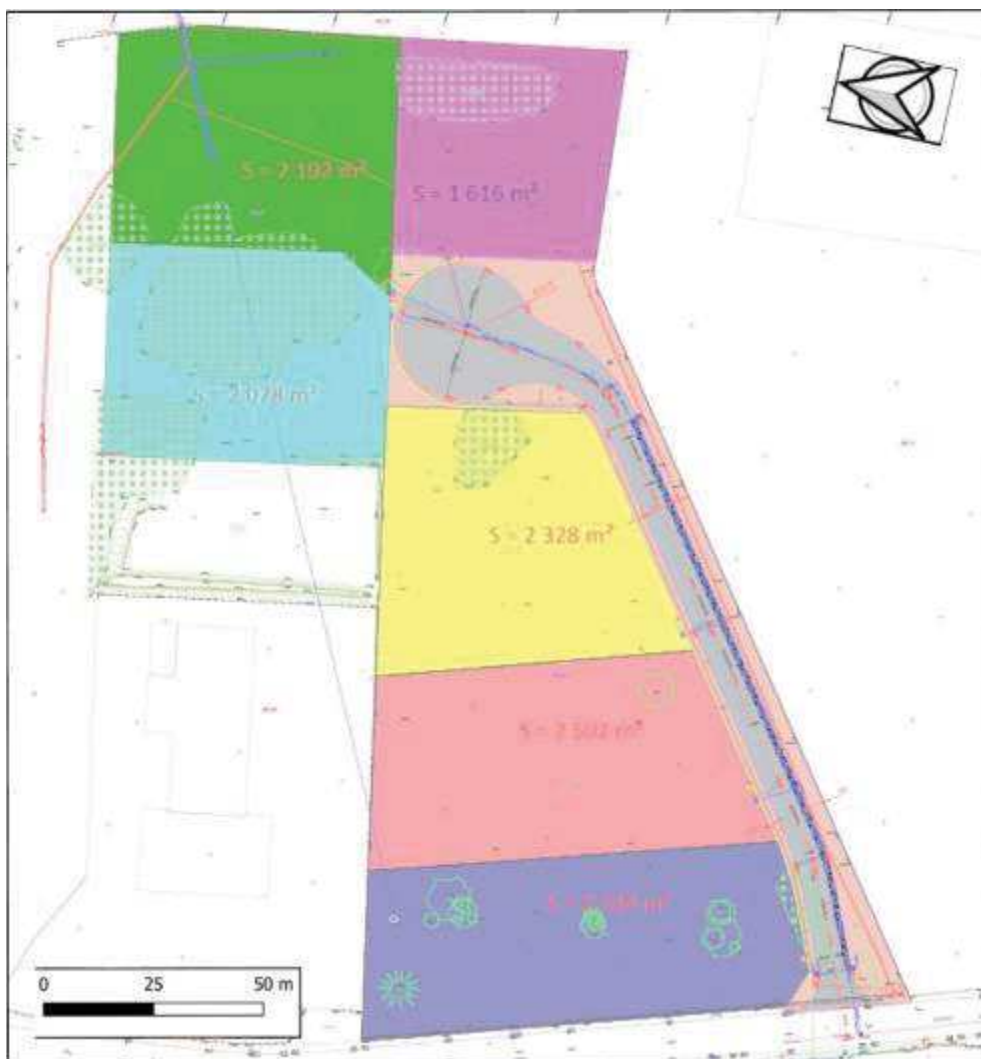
PLAN MASSE DU PROJET (SOURCE : NOVIM)
